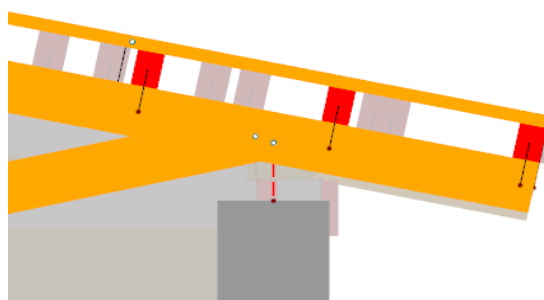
Pohled na výstavbu skutečné střešní konstrukce
